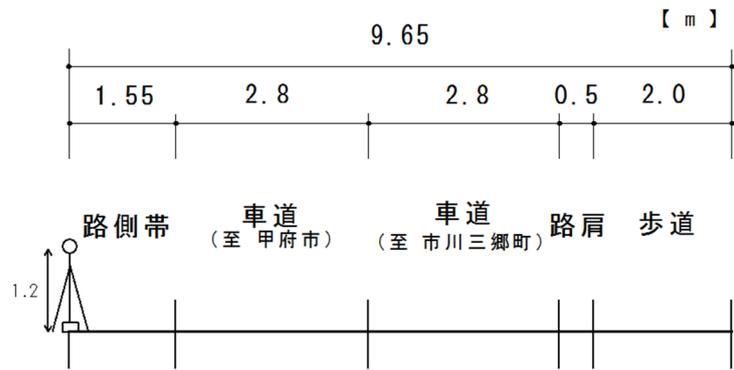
(3) 道路断面図 (RA3、RNV3)
